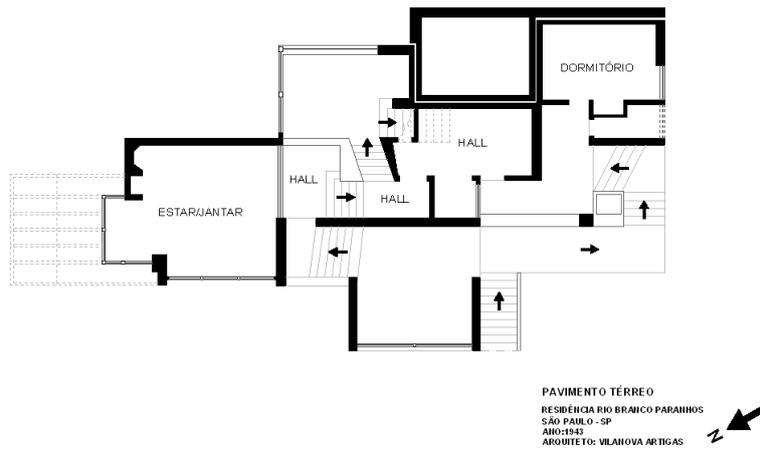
Redesenho da planta baixa térrea da residência de Rio Branco Paranhos, 1943.
